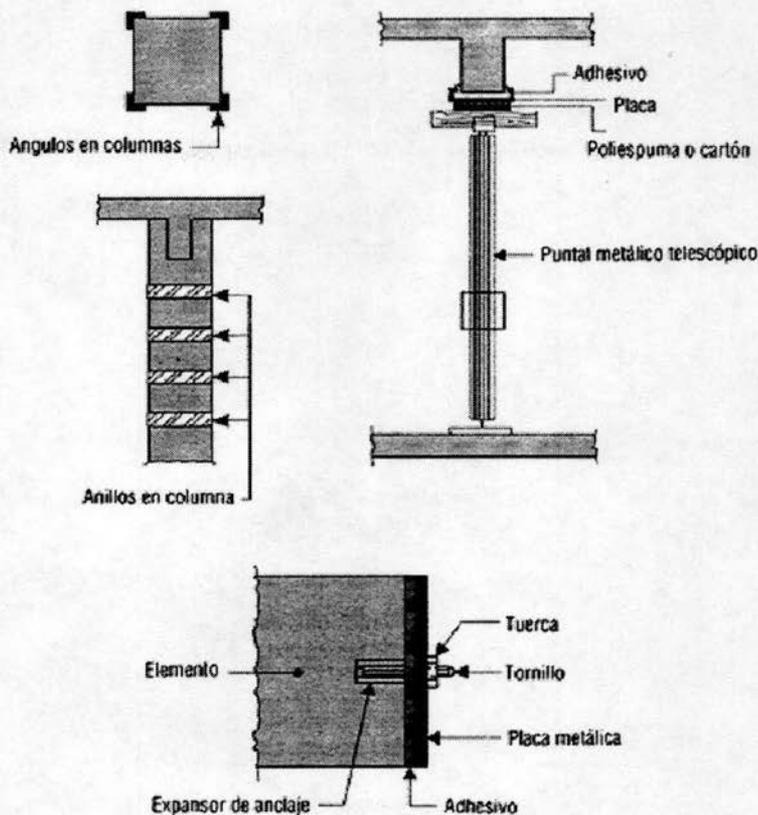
Refuerzos – Placas metálicas adheridas al concreto con mortero de base epoxica
